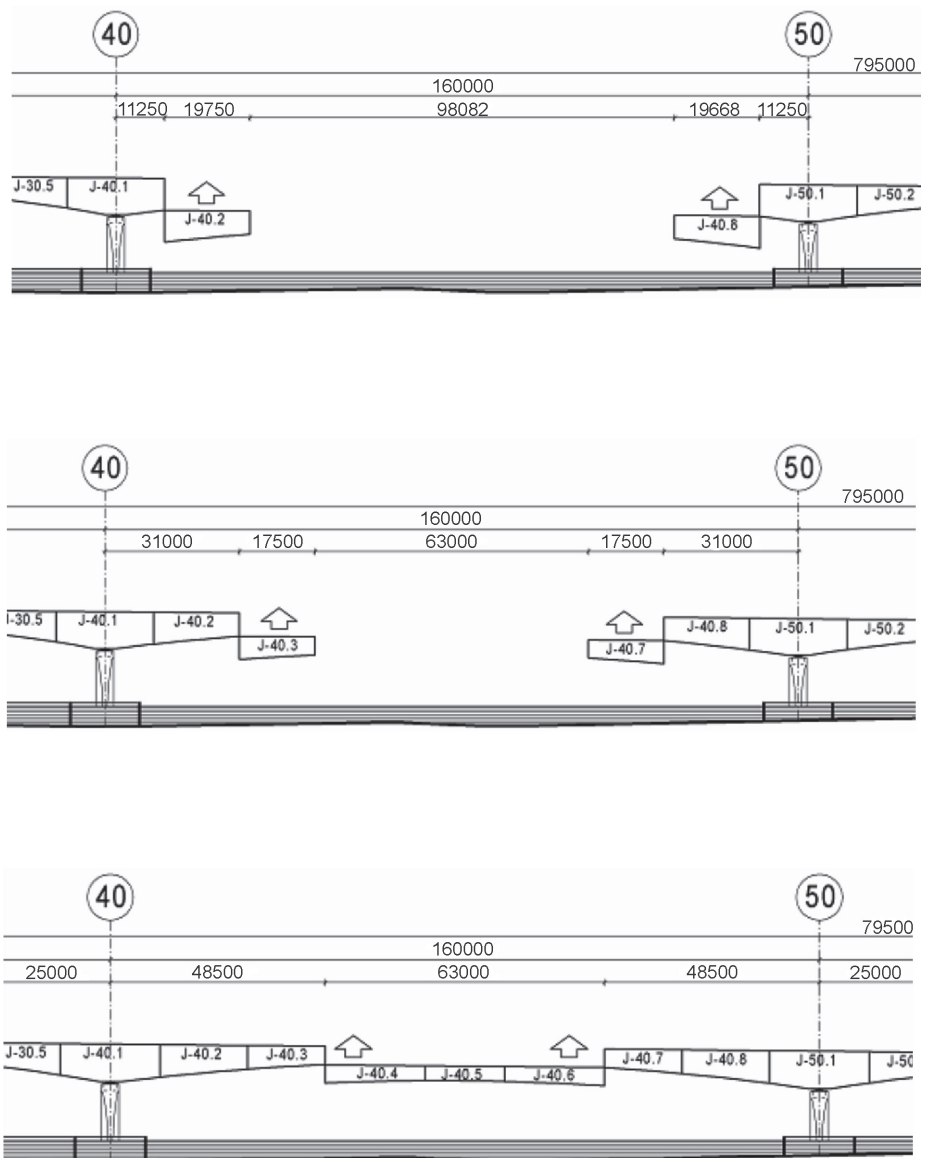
Przygotowanie do podciągania części konstrukcji mostu
